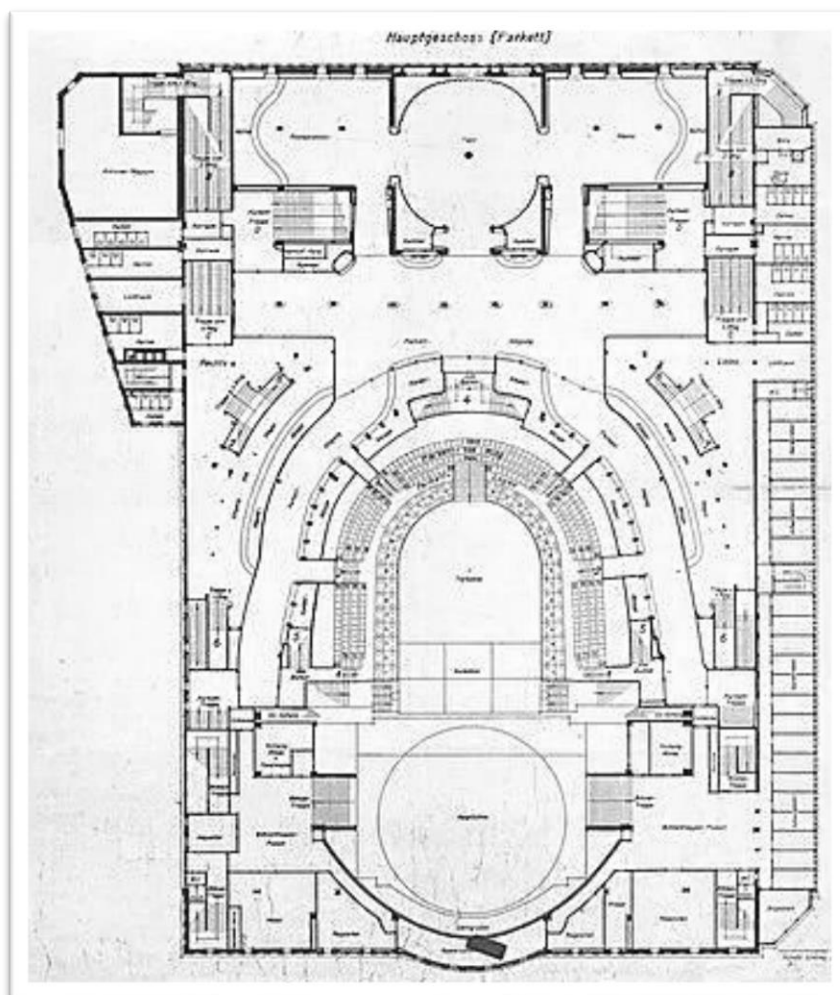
Planta do *Grosses Schauspielhaus*.
